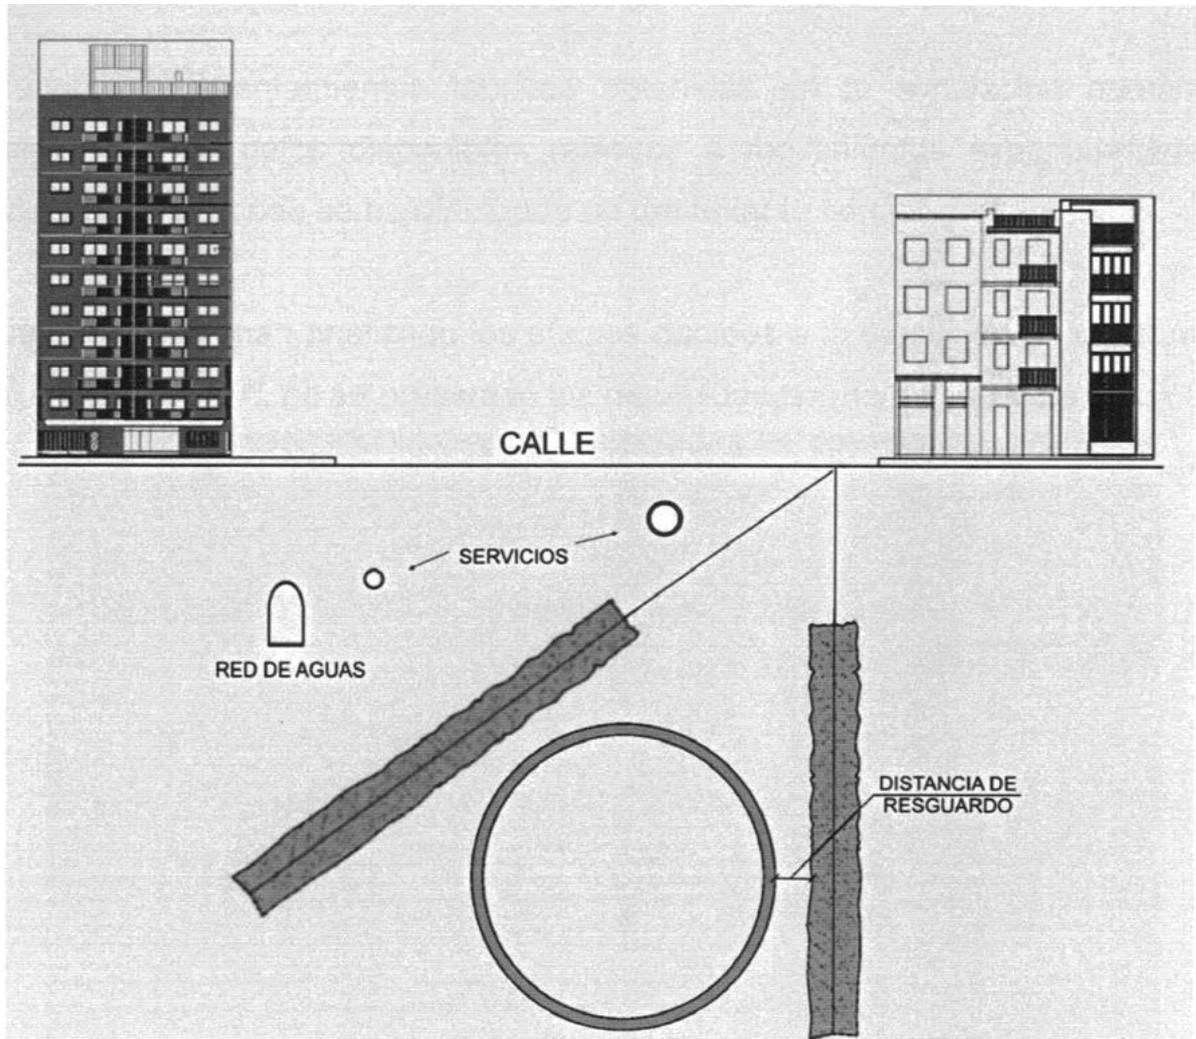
Pantallas de jet grouting de protección de edificios y servicios para la excavación de túneles
